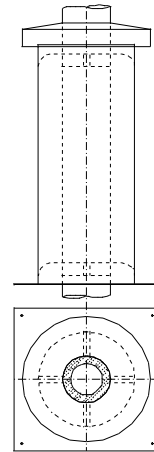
Aufbau Stulprohr mit integrierter Ablufführung
